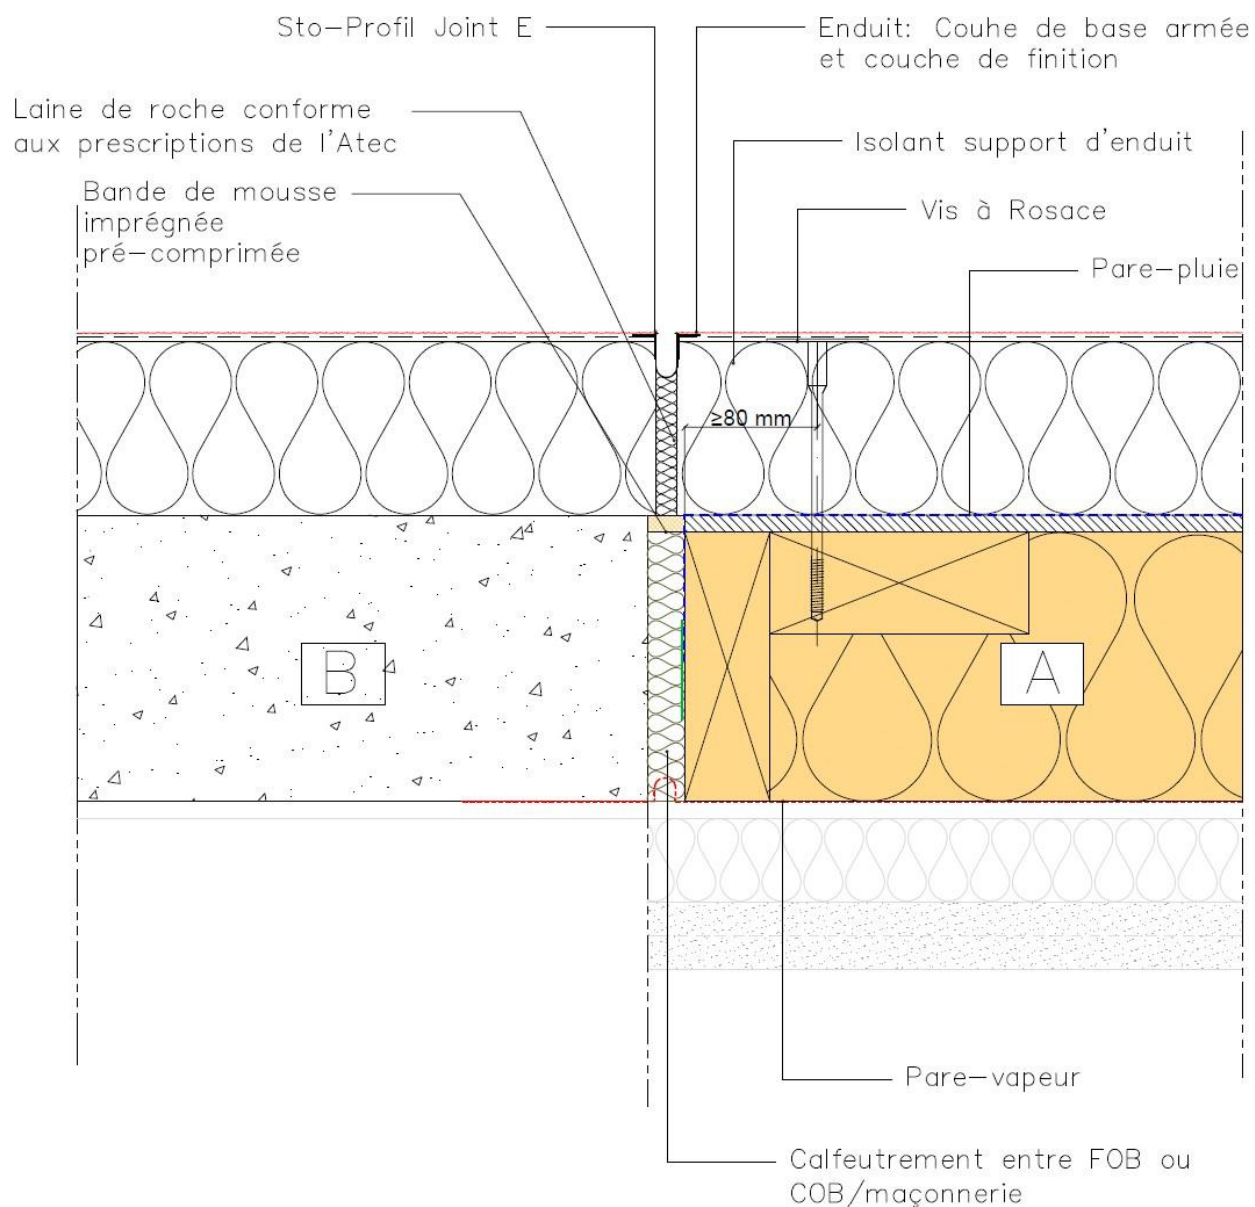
Jonction FOB / Voile BA (ou maçonnerie) dans le même plan et avec ETICS - Sto-Profil Joint E - Coupe Horizontale
